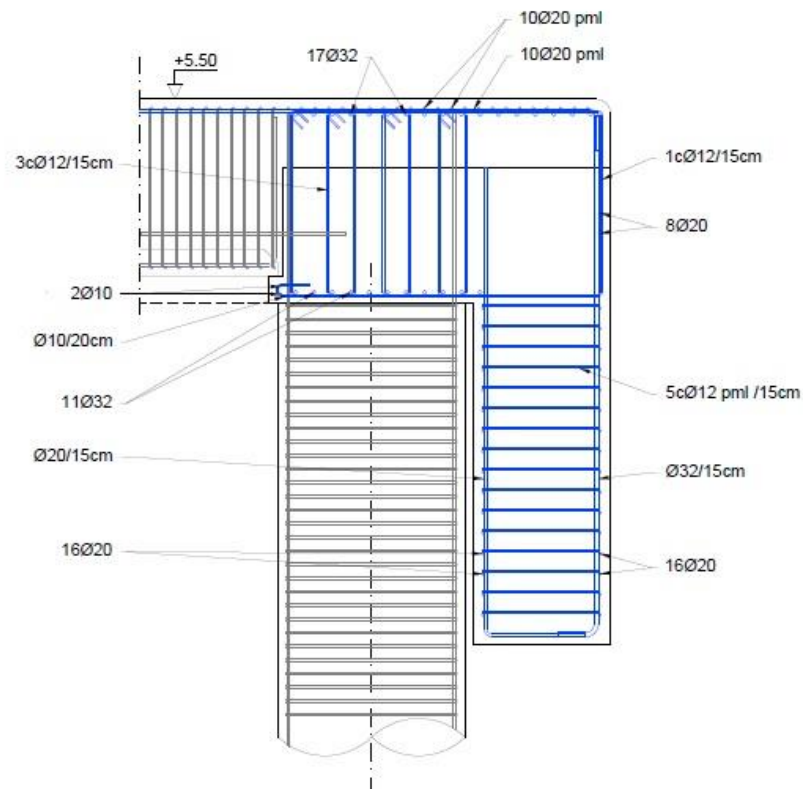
Detalle de armado viga longitudinal. (Elaboración propia)
